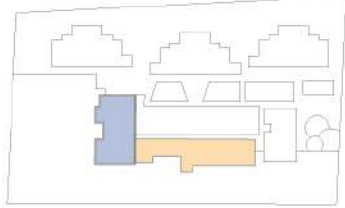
Planta arquitectónica de la zona administrativa y la zona pública
